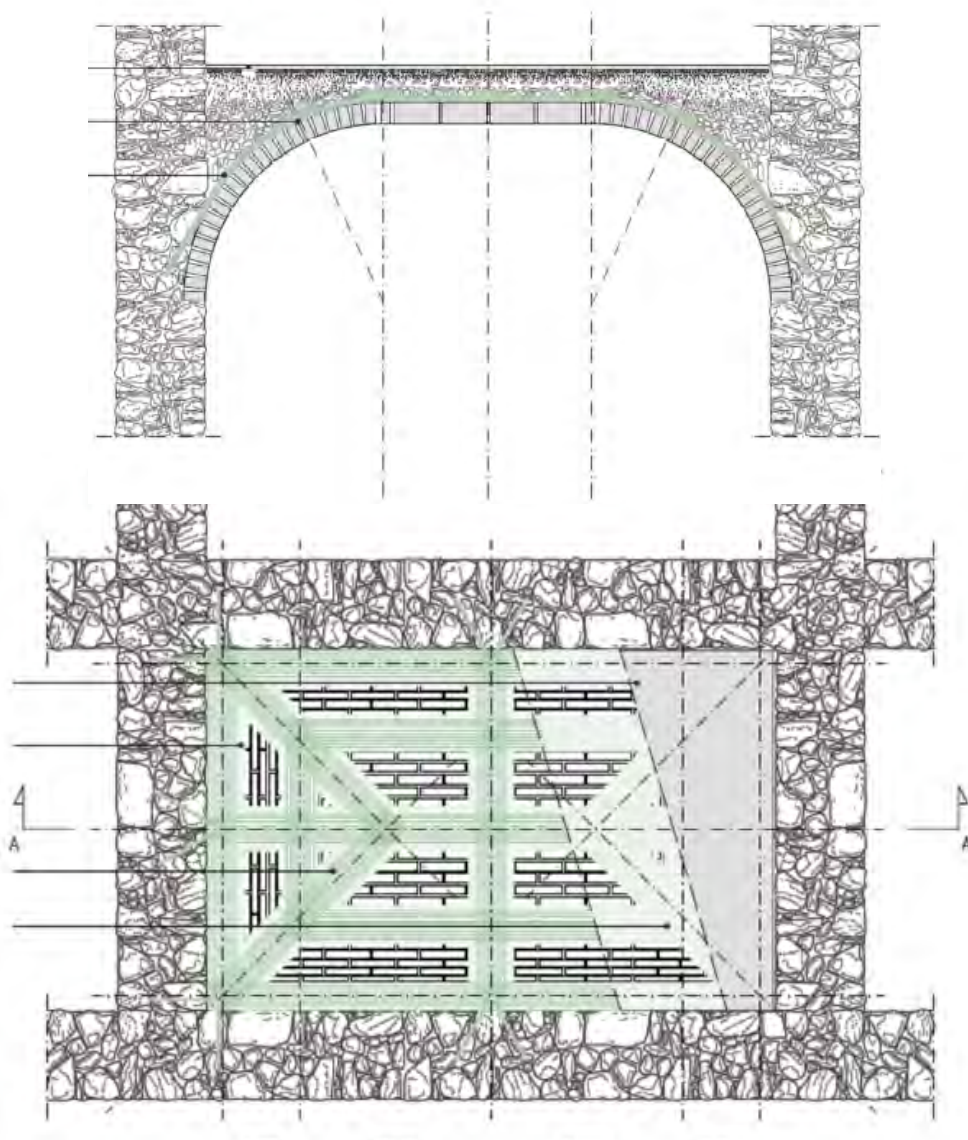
schema di intervento tipo all'estradosso della volta
